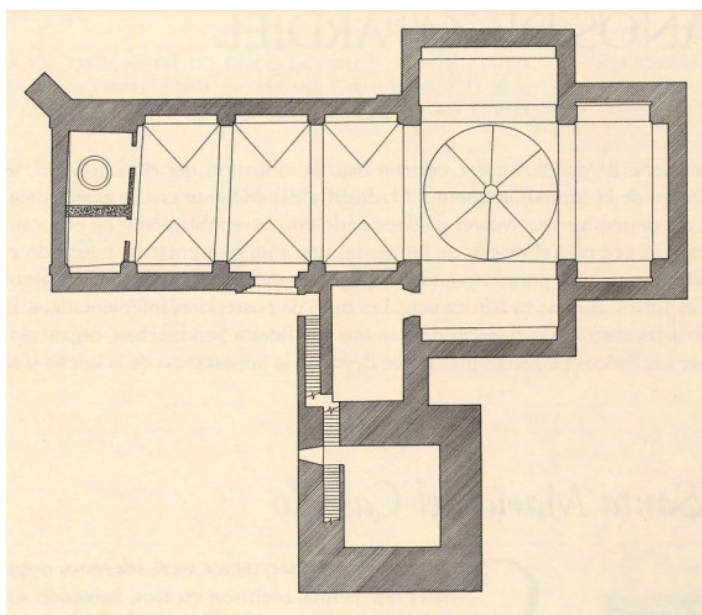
Planta de M. T. Sánchez Trujillano⁷². 2002.
